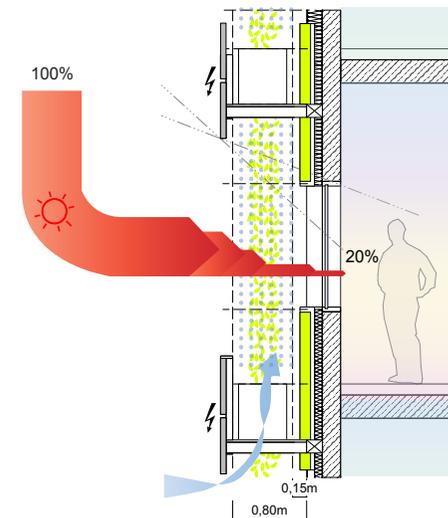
Fassade mit Photovoltaik und Fassadenbegrünung
